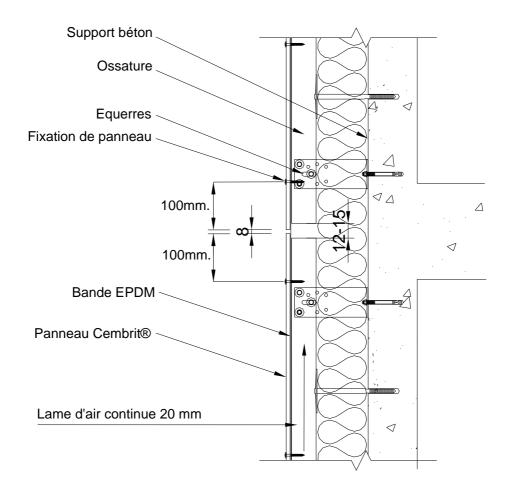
Joint de fractionnement au droit de chaque plancher - Coupe verticale
